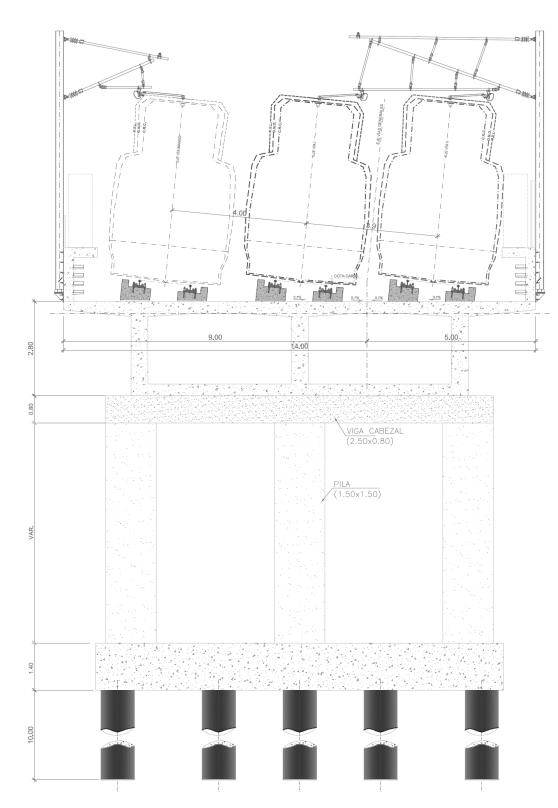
Sección estructural tipo para viaducto con tres carriles y luz de 40 m
